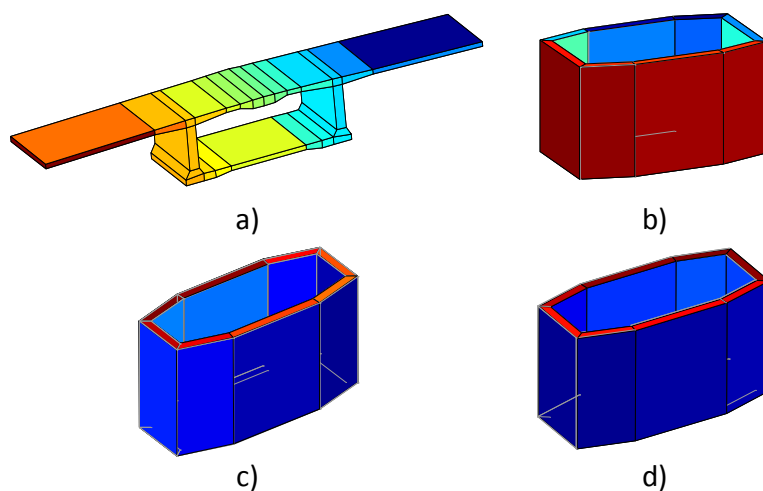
Representação tridimensional das secções: a) tabuleiro; b) pilares 15 e 22; c) pilares 16 e 21; d) pilares 17 e 20.
